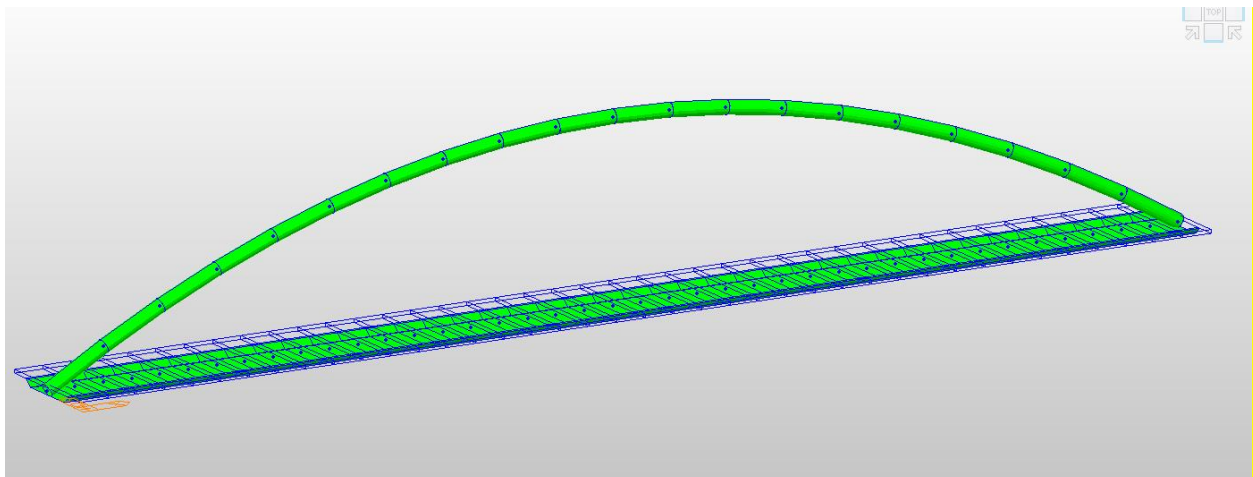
Modelo 5: Un arco centrado con tablero sección en cajón
